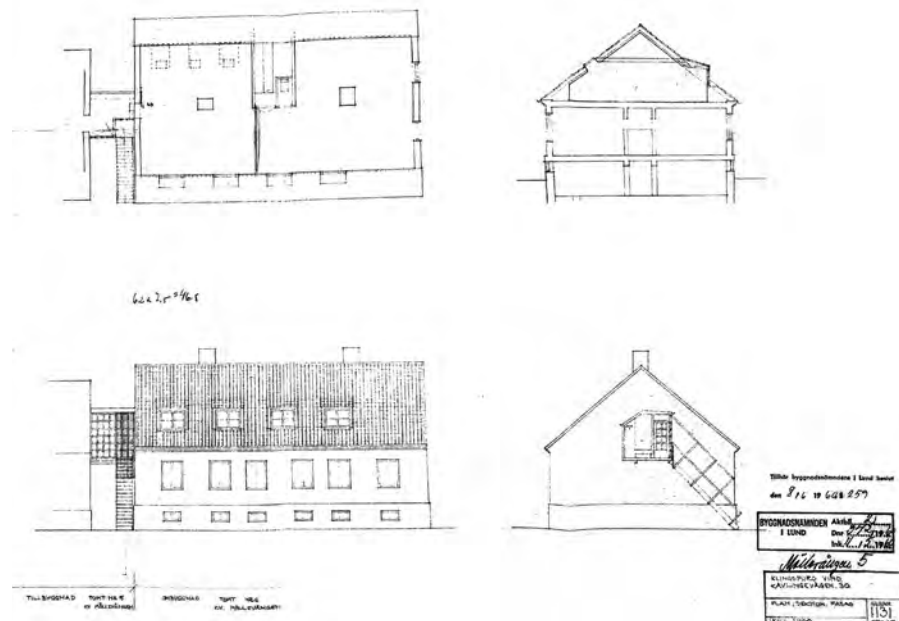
Croquis en alzado, planta y sección de la ampliación hacia el desván del vecino, hacia la casa situada en el número 30 de la calle Kävlingevägen. Están fechados en 1960. Aunque la obra no se llevará a cabo hasta 1964. El alzado aún no muestra las ventanas triangulares definitivas, similares a las construidas en el desván de Anshelm. En ellos se muestra la primera opción para acceder al desván del vecino. Una escalera de un solo tramo accede directamente al puente cristalino. ArkDes.
